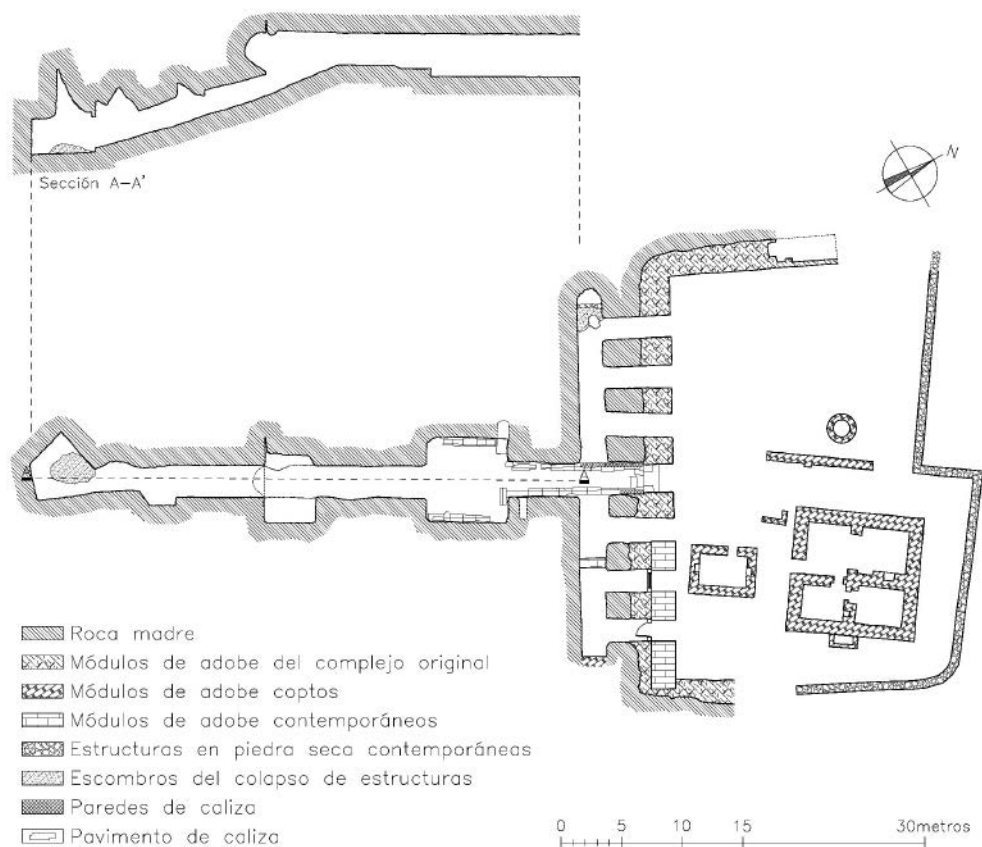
Planta y sección de la TT 103 de acuerdo a su actual estado de conservación
